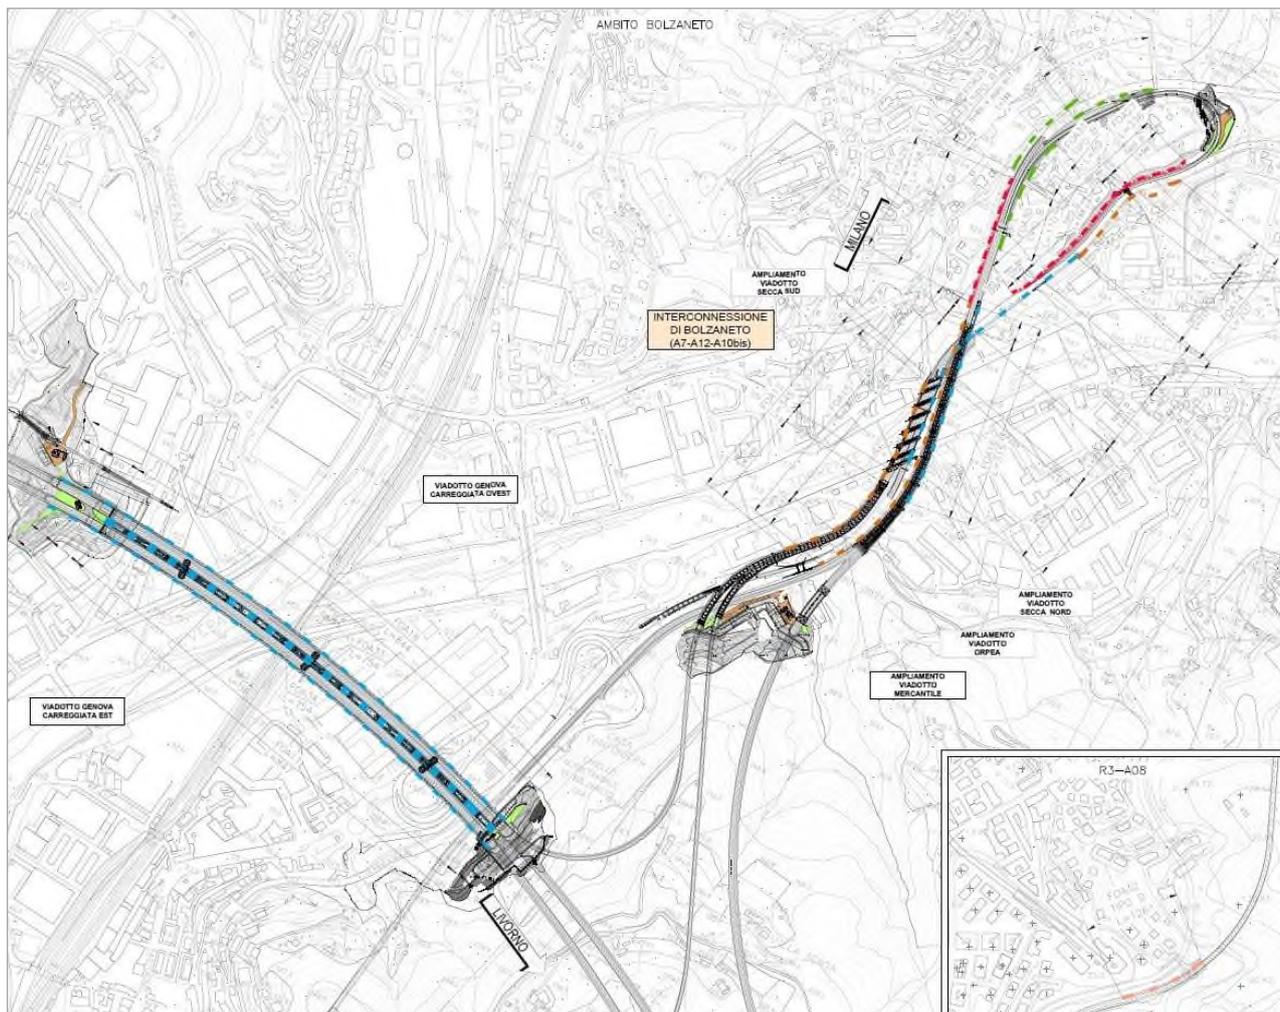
Layout barriere acustiche - Area Bolzaneto.
